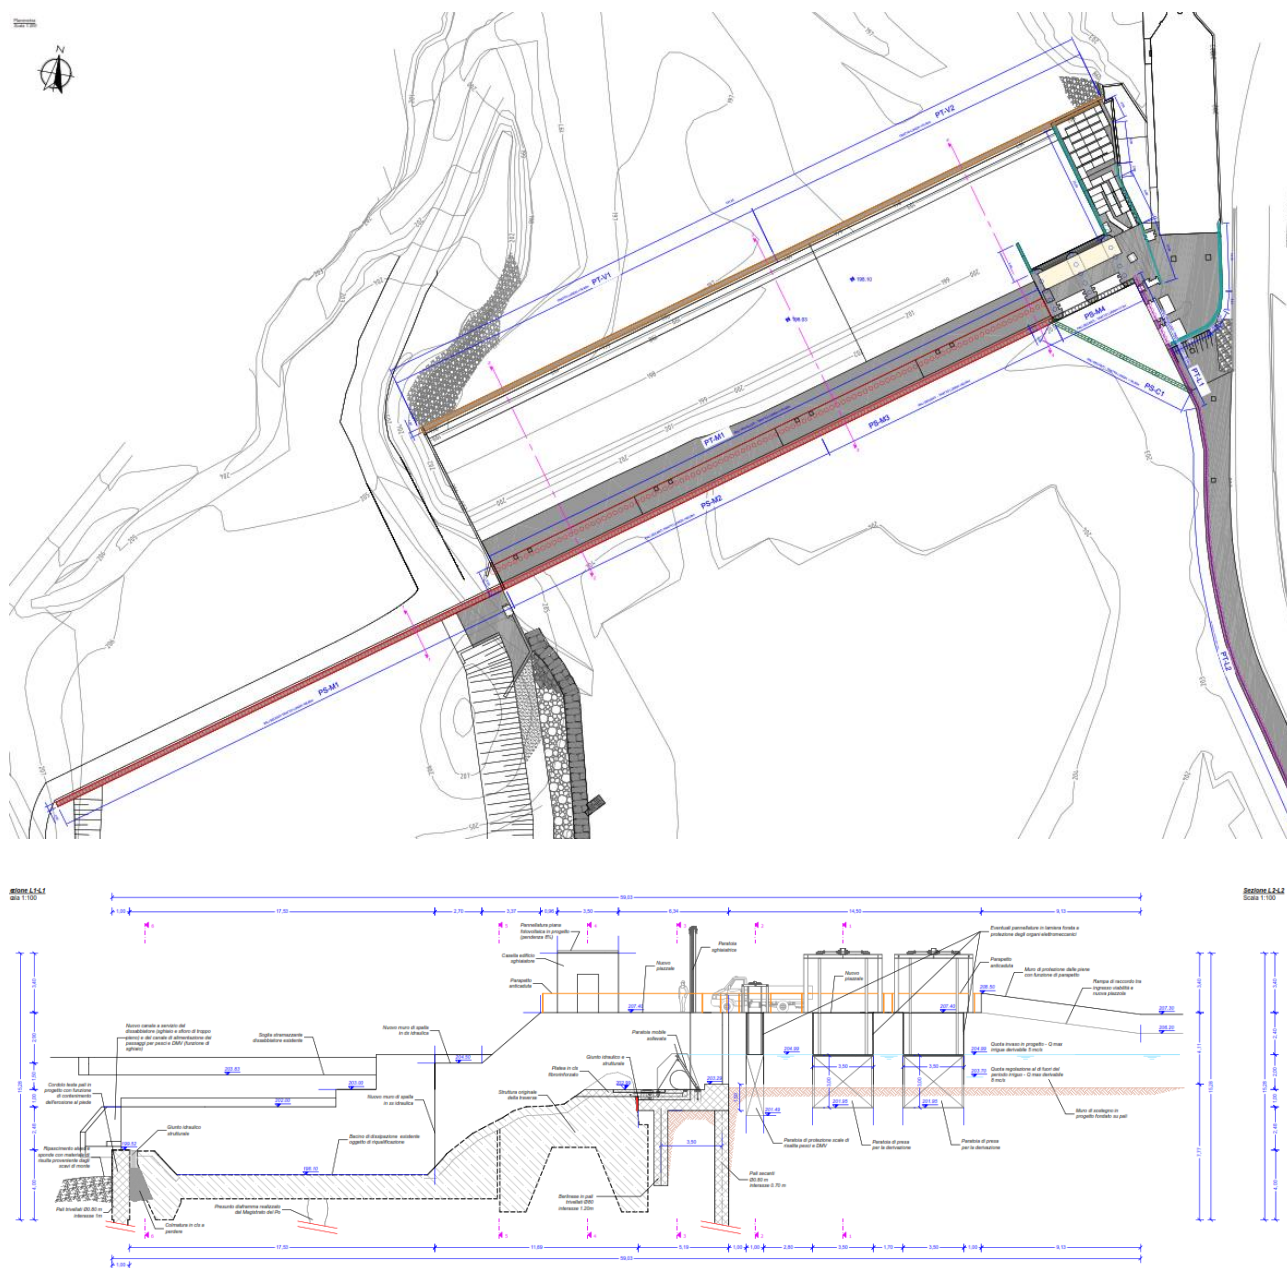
estratto di planimetria e sezioni delle opere derivate dalle tavole progettuali 3.1.1 e 3.1.5
